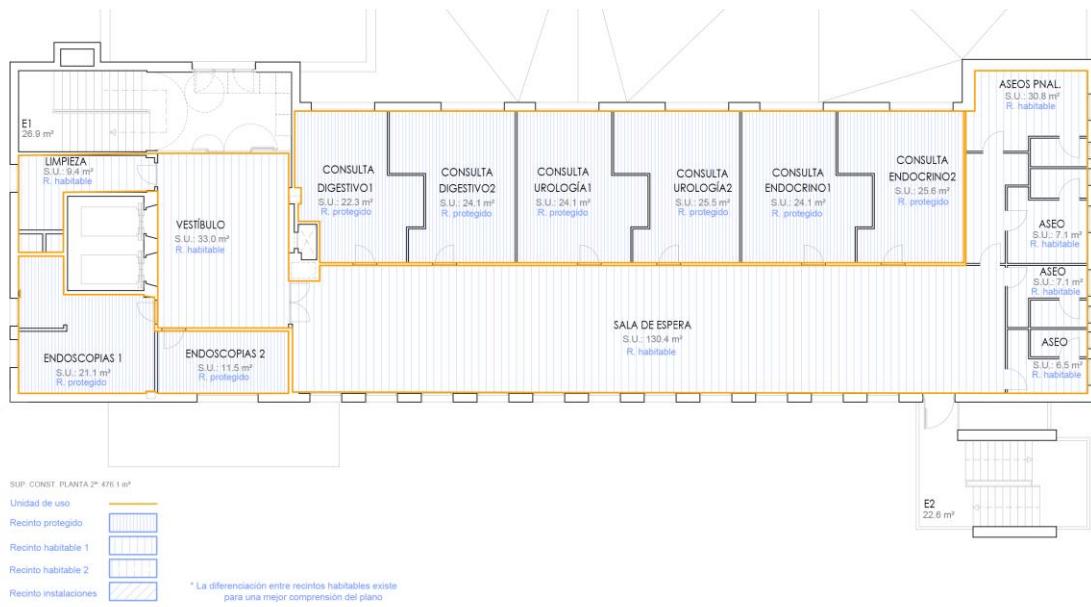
Planta de recintos de la planta segunda. (Planta tipo)
